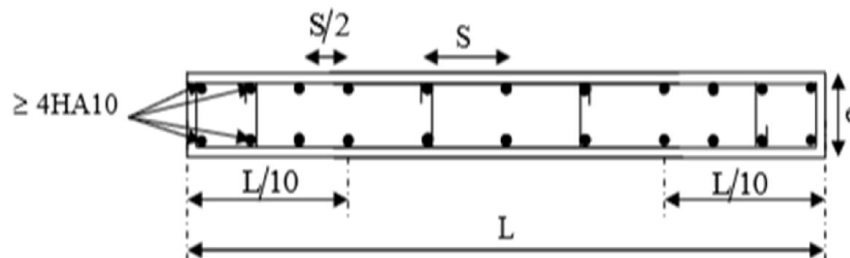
Disposition des armatures verticales dans les voiles
